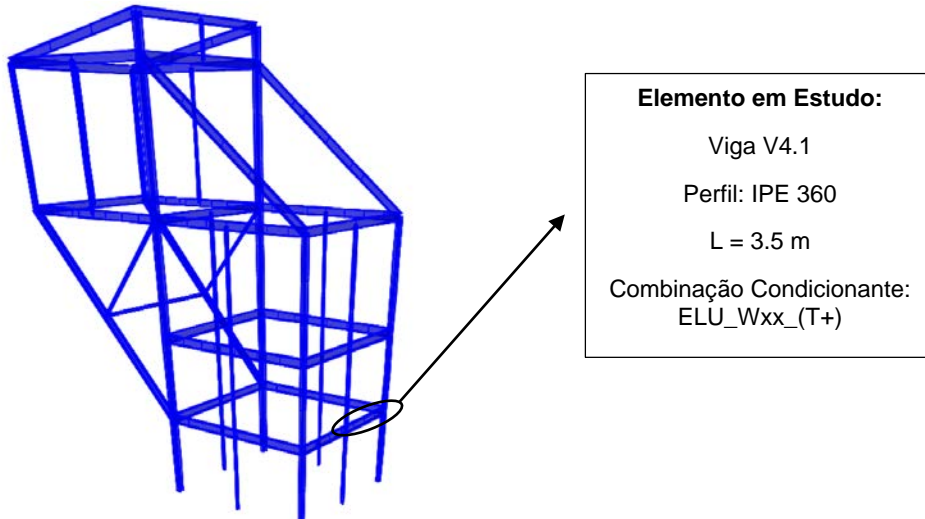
Localização da Viga V1.4 da Travessa do Pórtico B
